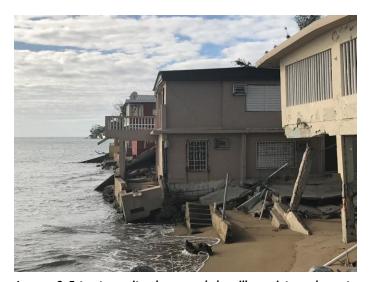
Estructuras situadas cerca de la orilla y sujetas a desgaste y erosión.
